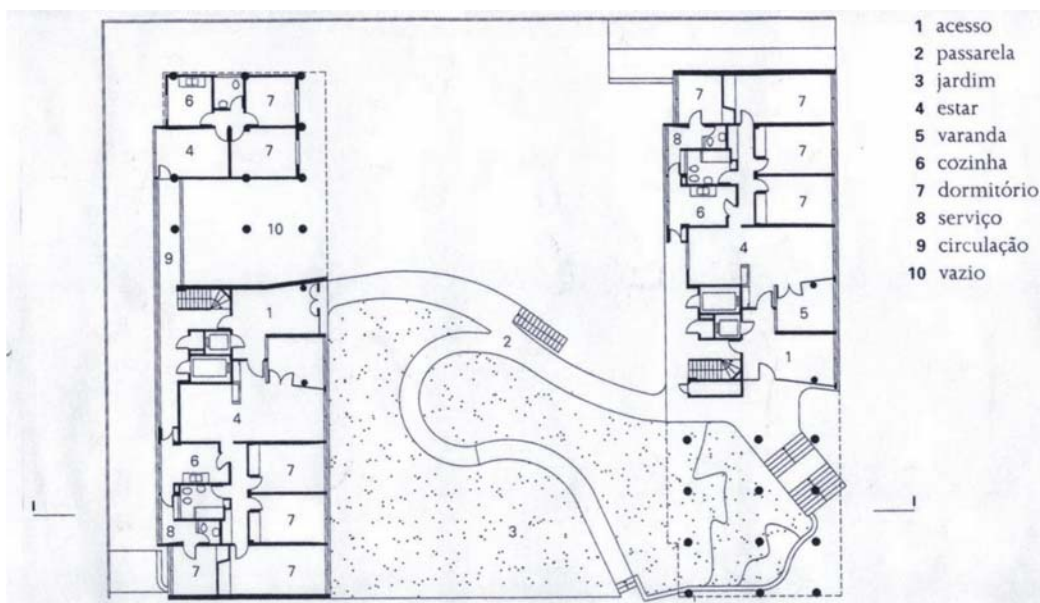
Planta do pavimento térreo e do apartamento tipo.
